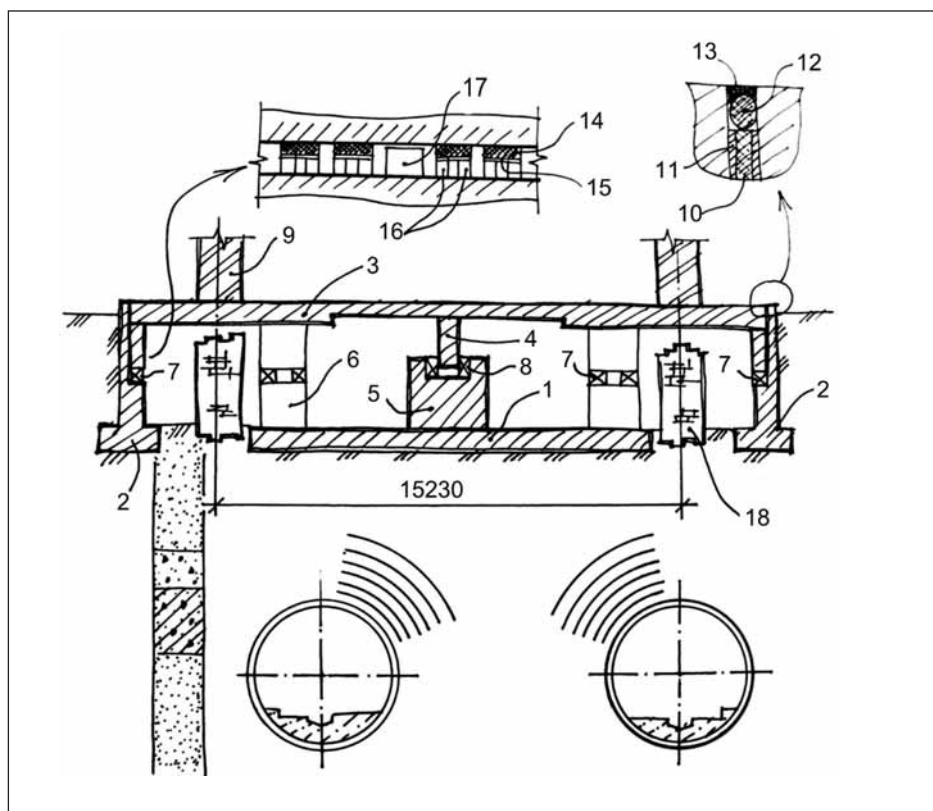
Принципиальная схема виброизолированного фундамента воссоздаваемого здания церкви Святого Духа (концертный зал «Верхний город»): 1 – фундаментная плита внутреннего контура; 2 – наружный ленточный фундамент; 3 – распределительная плита; 4 – «маятник»; 5 – упор; 6 – пилон; 7 – узел вертикальной виброизоляции; 8 – горизонтальный виброизолятор; 9 – стены вновь возводимого здания; 10 – вспененный полиэтилен; 11 – асбестоцементные листы; 12 – пористый уплотнитель; 13 – герметик; 14 – виброизолятор из специального полимерного материала; 15 – стальная пластина; 16 – опора виброизолятора; 17 – страховочная опора «ловушка»; 18 – сохранившиеся конструкции старых фундаментов
